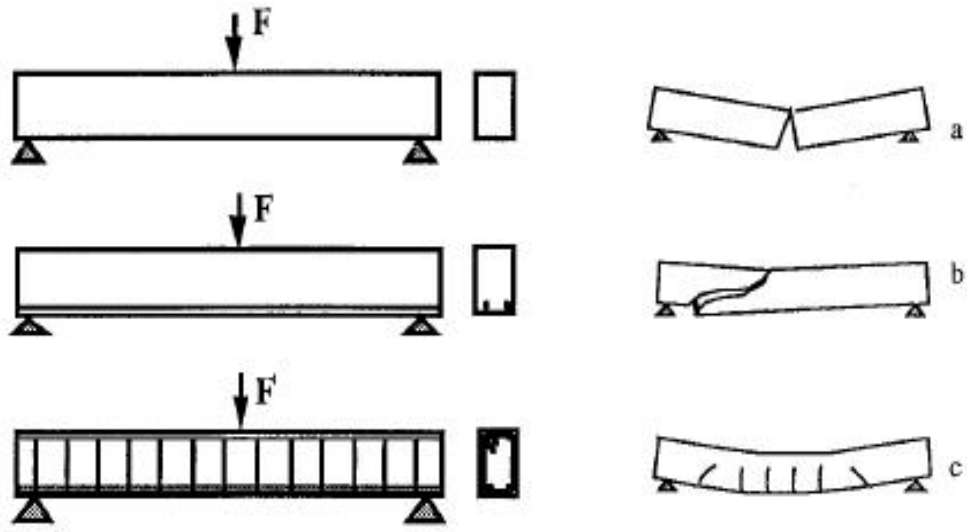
Cas d'une poutre en béton flexion 3 points.
